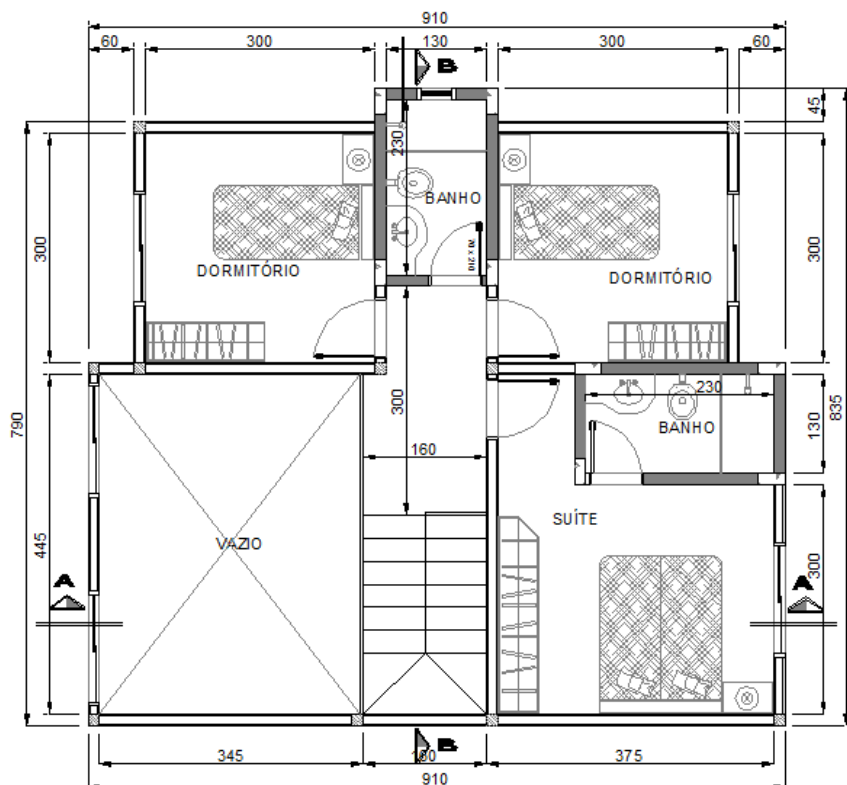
Planta baixa do primeiro pavimento - sem escala. Fonte: do autor
